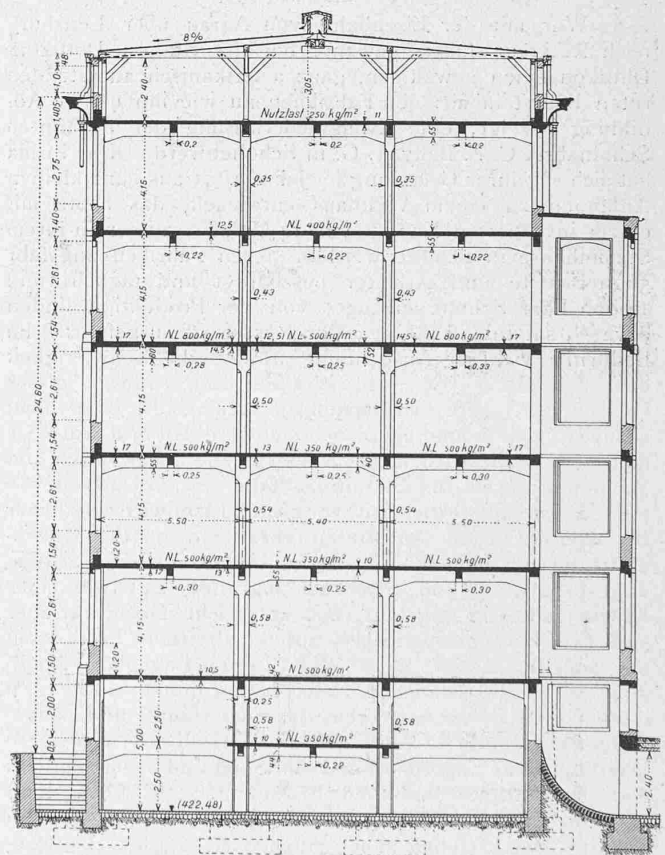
Querschnitt durch den Hauptbau mit Lüftungsschacht.
